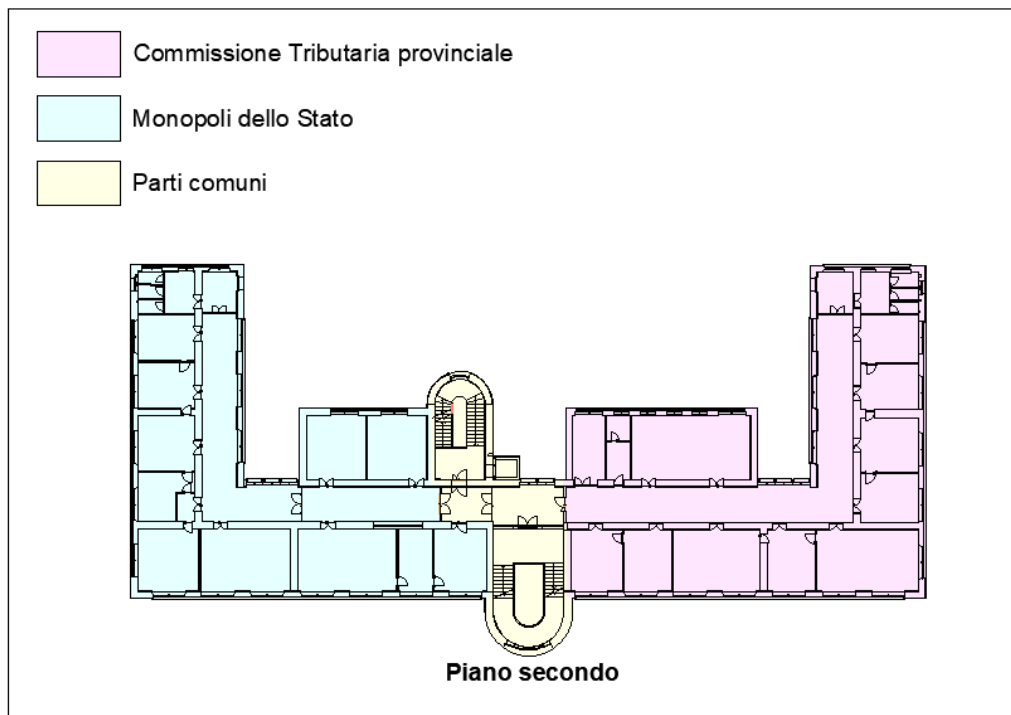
Pianta piano secondo: attuali Amministrazioni utilizzatrici
